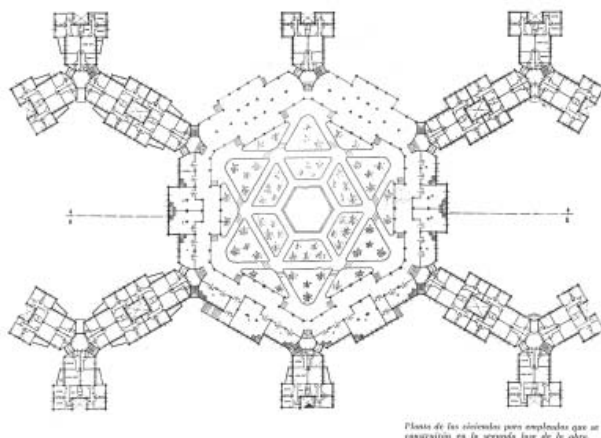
Plano de bloques en Y (solución descartada) Fuente: Revista Gran Madrid
